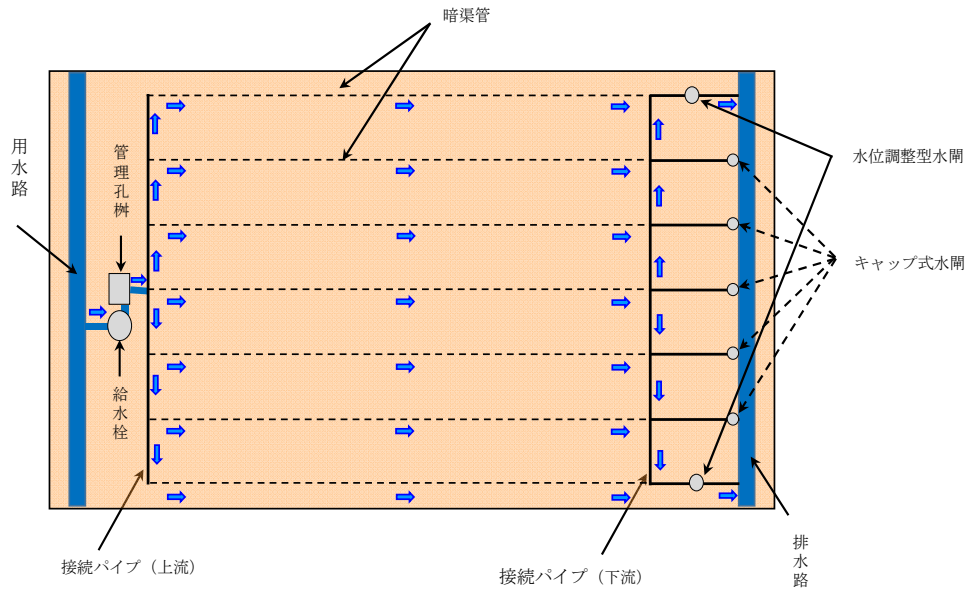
暗渠に管理孔柵を接続した地下かんがい事例（平面図）
